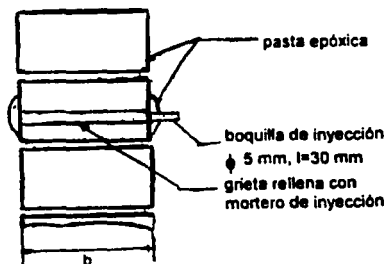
Reparación de grietas en estructuras de mampostería mediante inyección.
